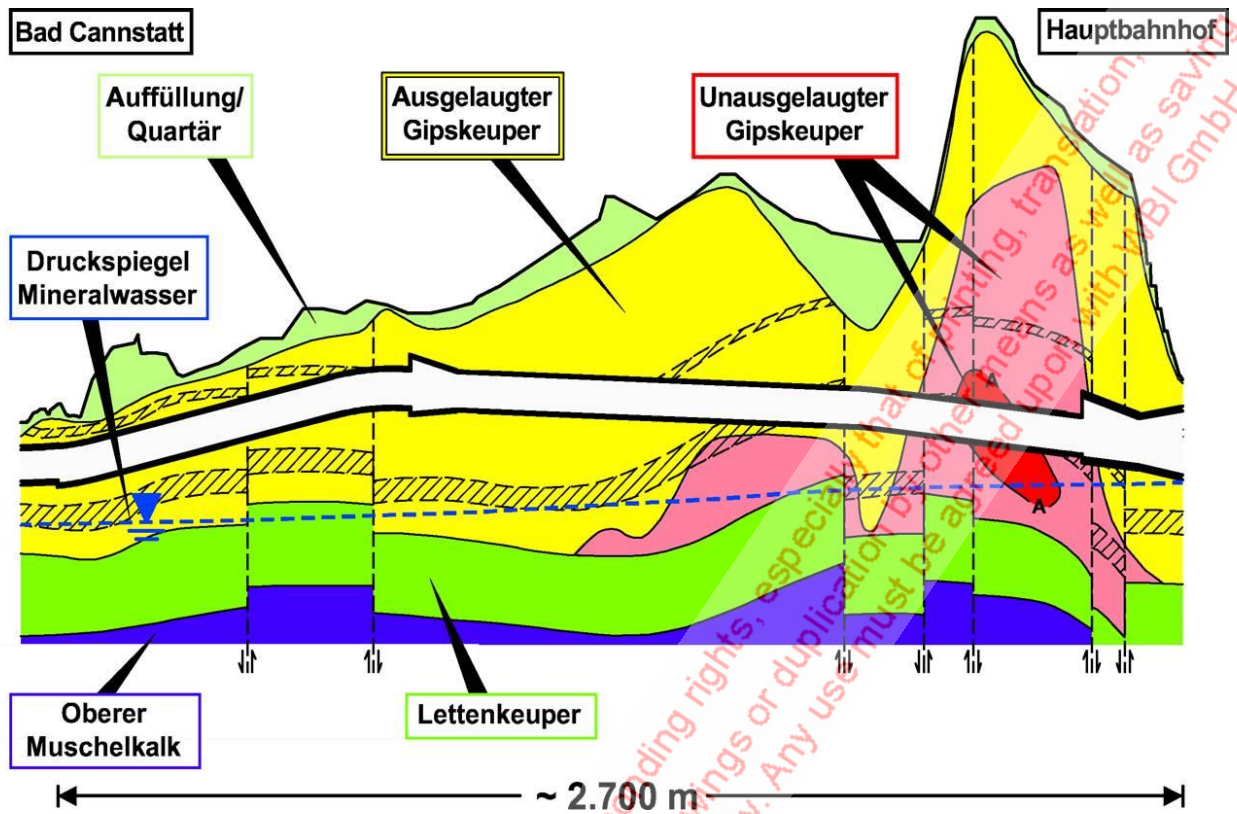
Tunnel nach Bad Cannstatt, A+I: Abdichtungen und Injektionen
